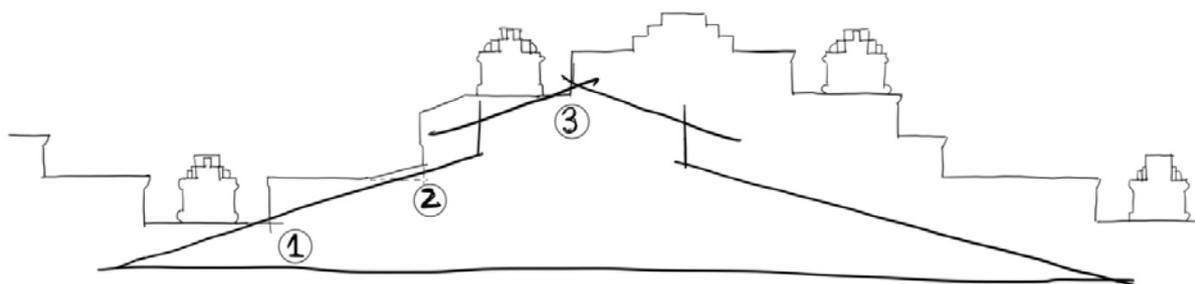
Patologías del alzado interior del muro posterior de una nave tipo. Fuente: elaboración propia.
